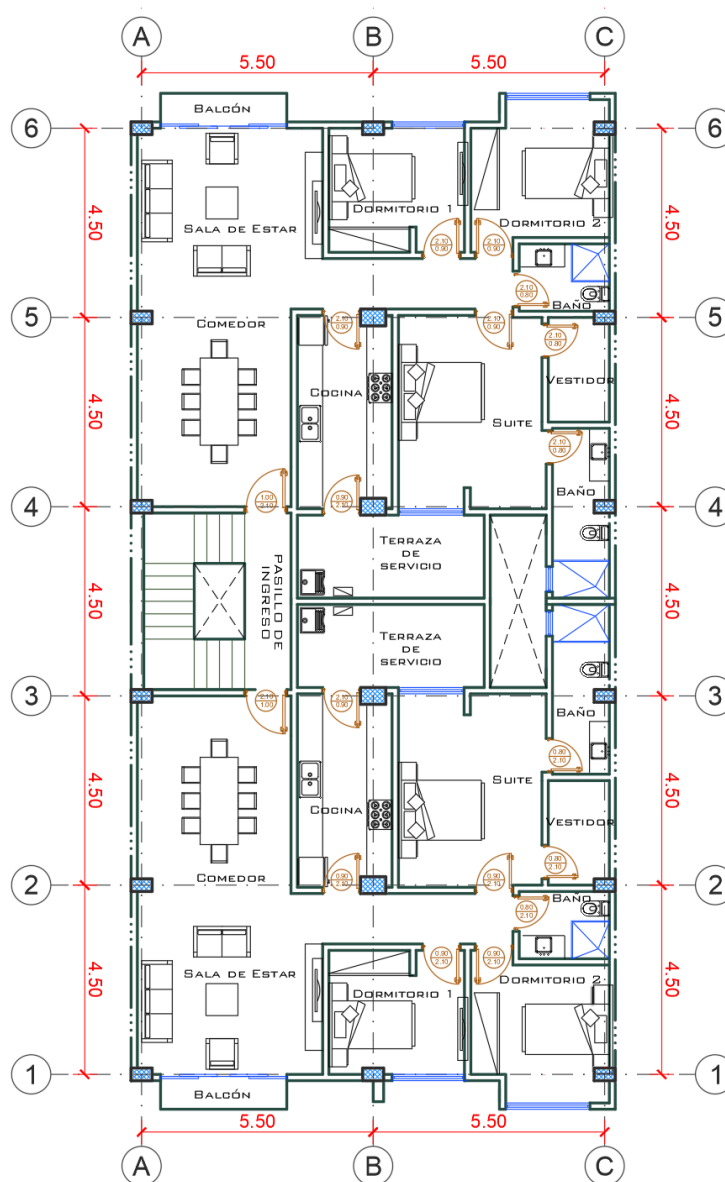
Distribución Arquitectónica de Departamentos Nivel 1-6.
